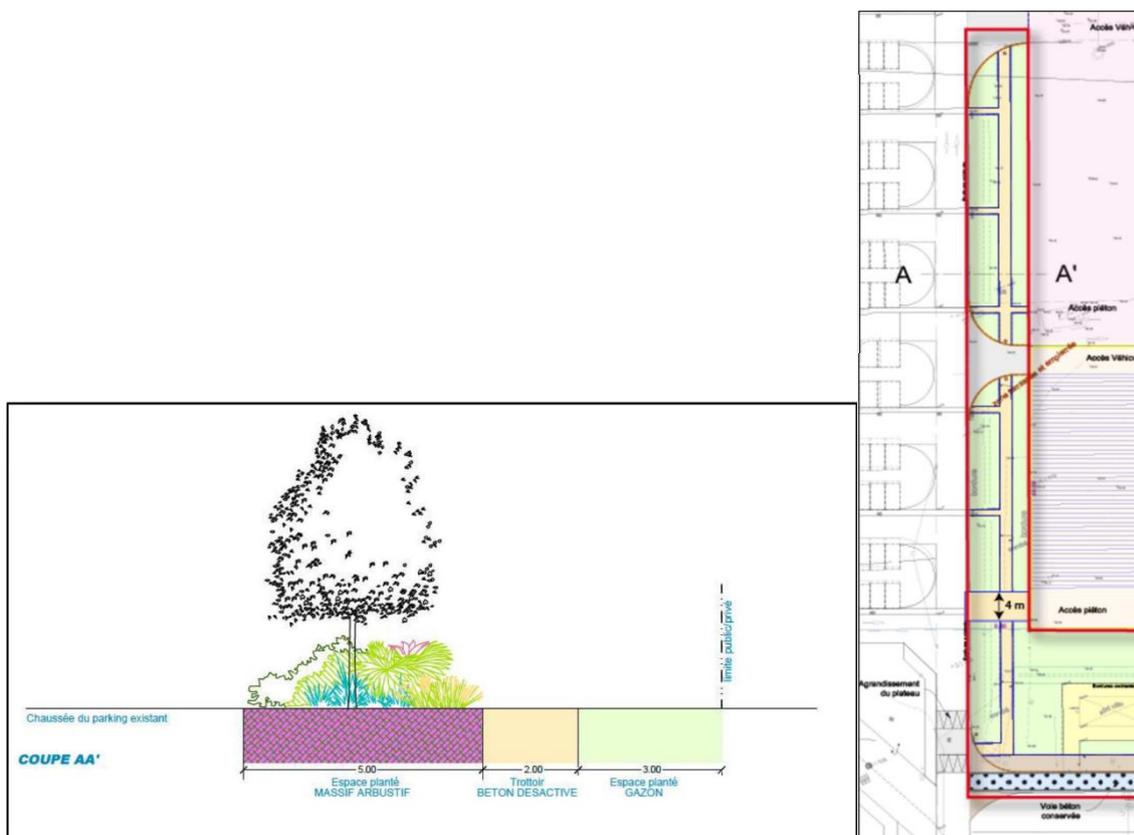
Plan et coupe du cheminement piéton nord-sud (source : Valence Romans agglo)
